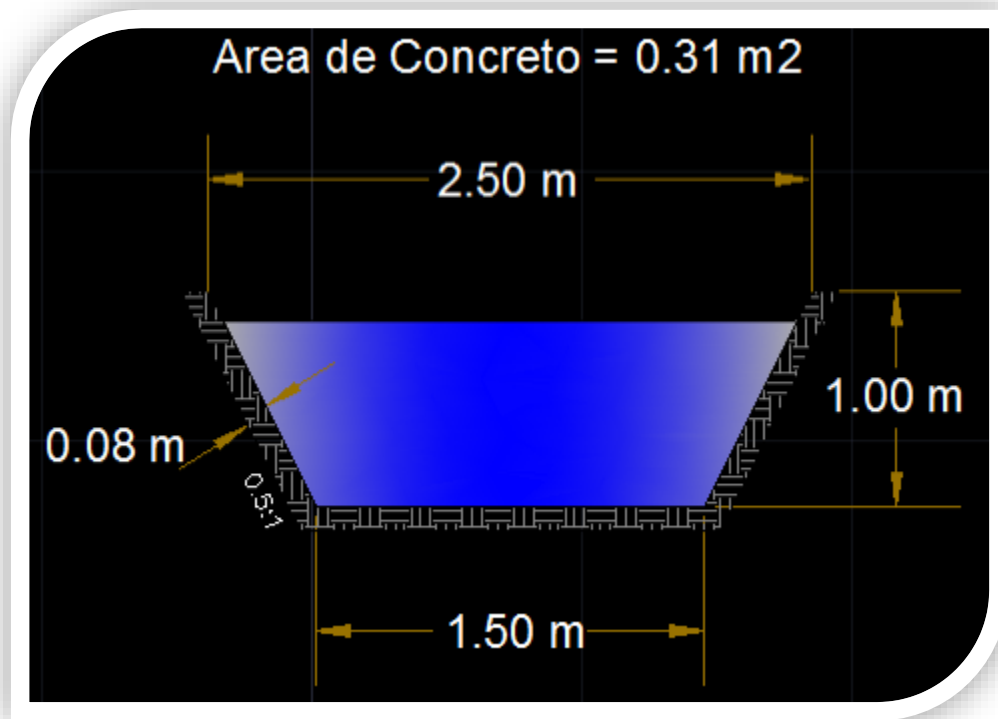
DETALLE DE CUNETA TRAPEZIAL EMPLEADA EN EL PROYECTO.
